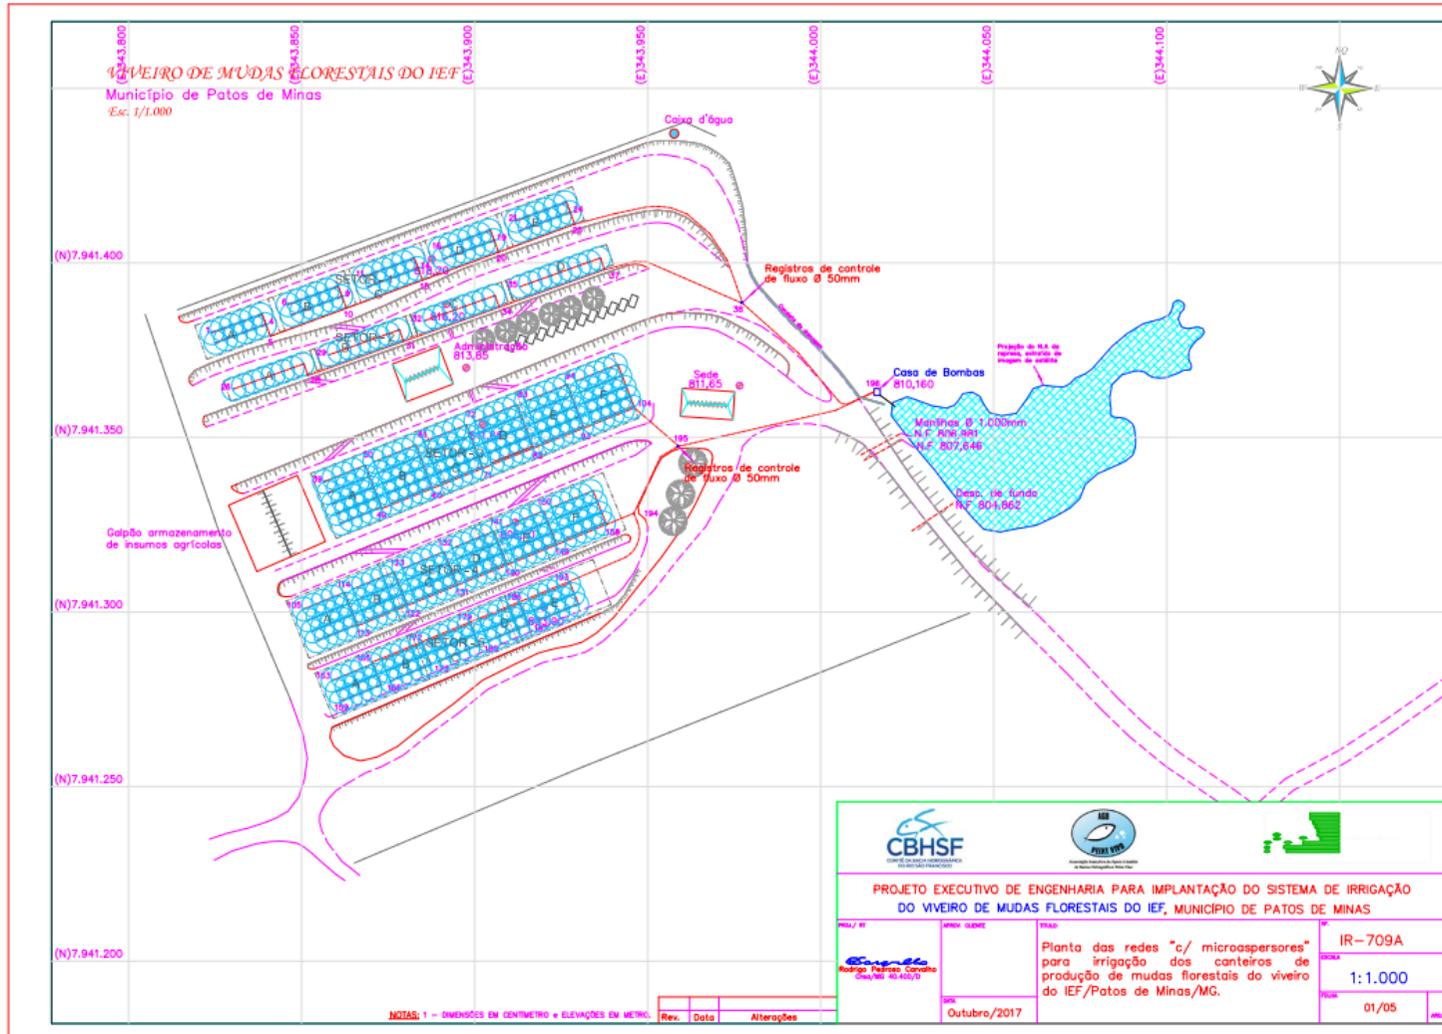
Layout da área onde será implantado o sistema de irrigação (fora de escala).
